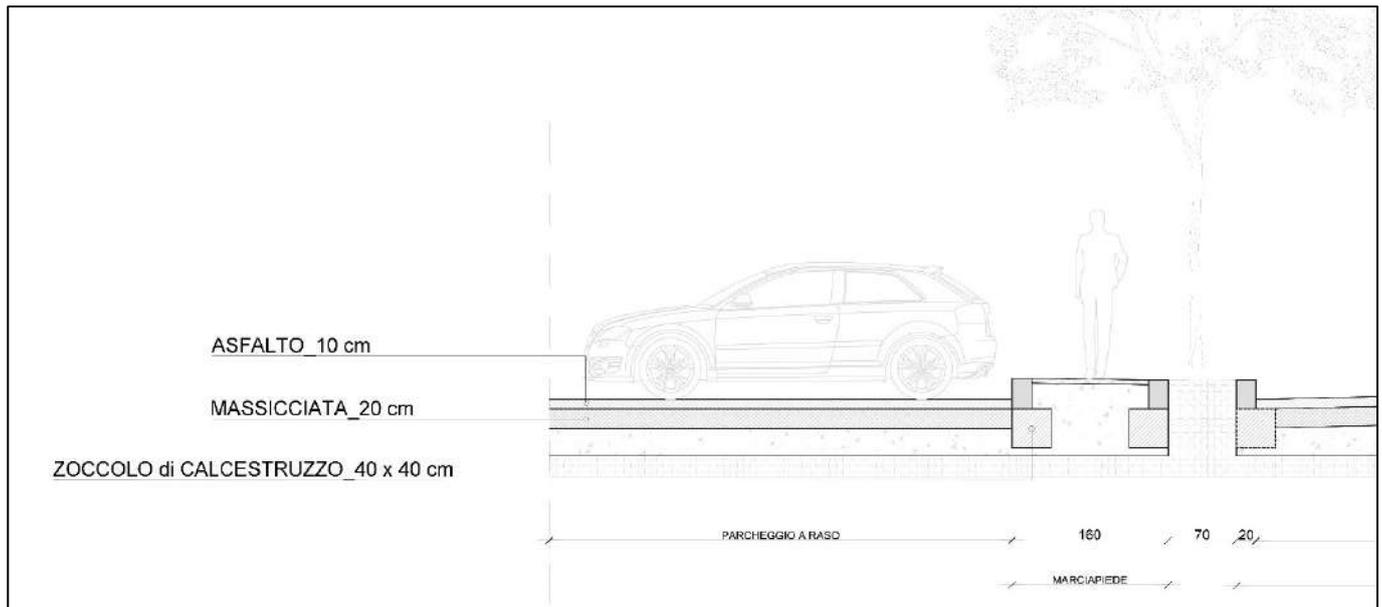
DETTAGLIO - SEZIONE T.3 SUB-AMBITO B.2
